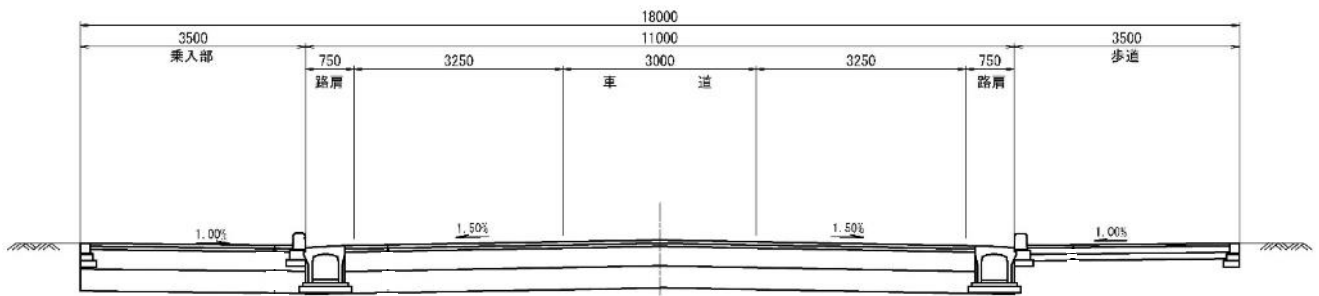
(1) 標準断面図 (主要地方道行田・蓮田線バイパス 幅員 18m)
